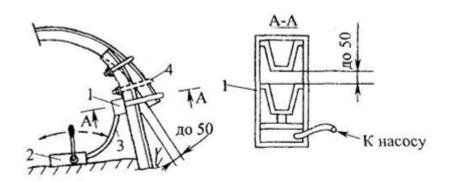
Схема восстановления сопротивления замкового соединения податливой арочной крепи из СВП путем частичного стягивания верхняка со стойкой и установки нового хомута (скобы, планки, гайки): 1 — стяжное гидравлическое устройство; 2 — ручной насос; 3 — высоконапорный гибкий шланг; 4 — новый устанавливаемый хомут
